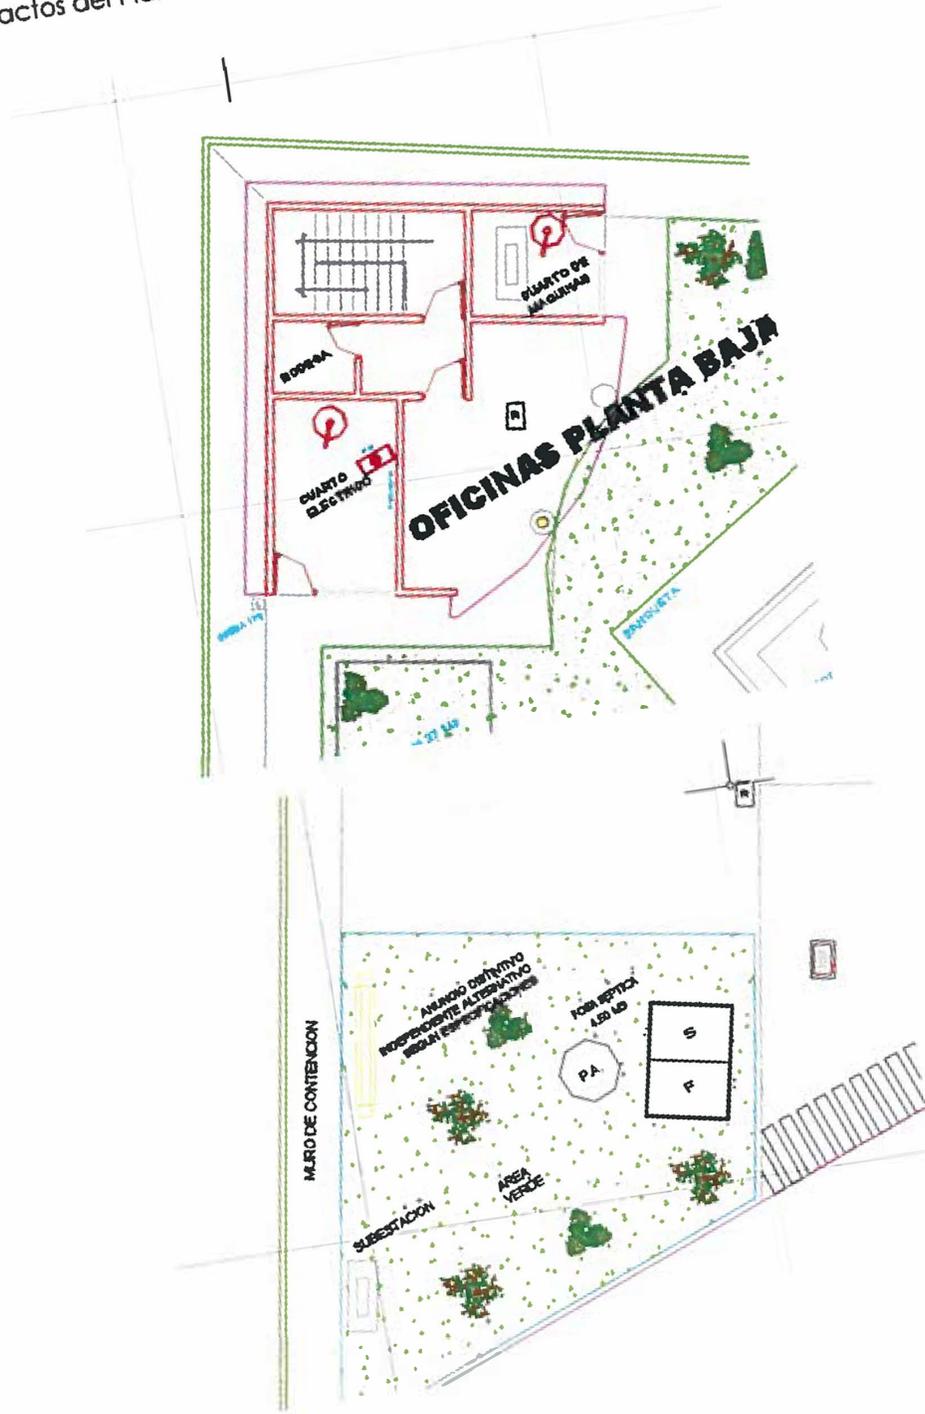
Extractos del Plano Arquitectónico del Proyecto
